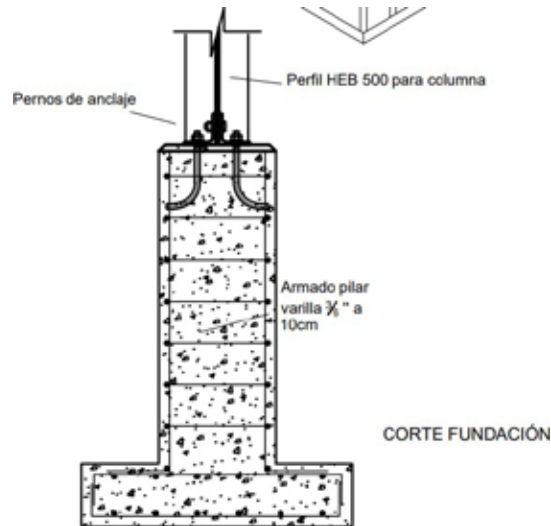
Detalle de Fundación de Columna HEB 300. Fuente: Autor (2021)
